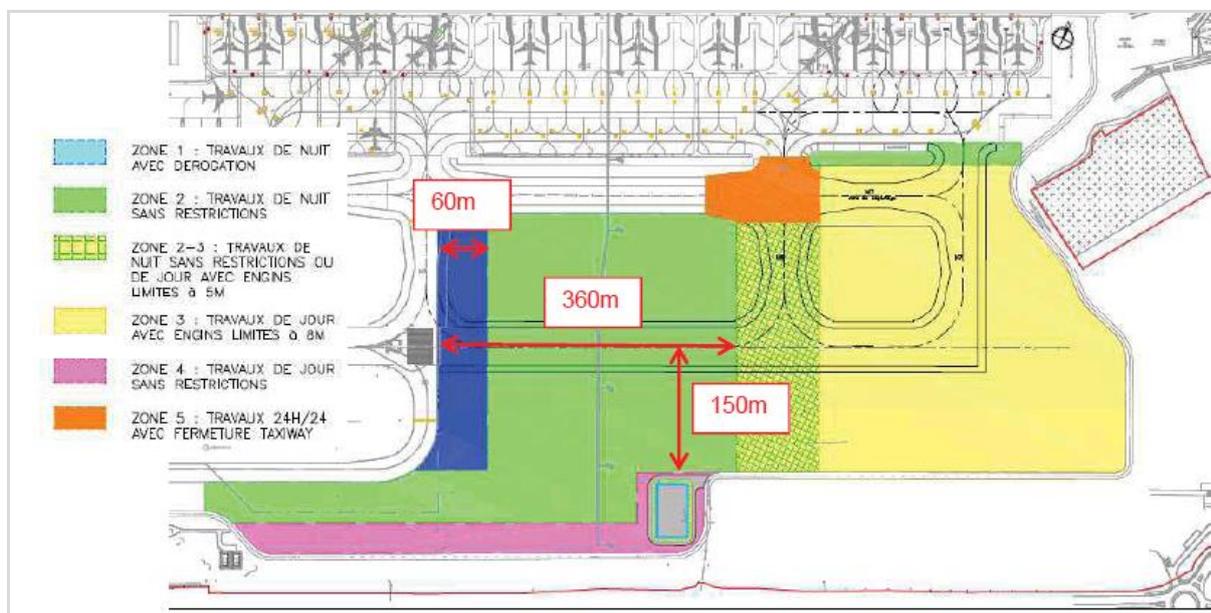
Plan de zonage des travaux (Source : Société Momentanée – SMBE)
